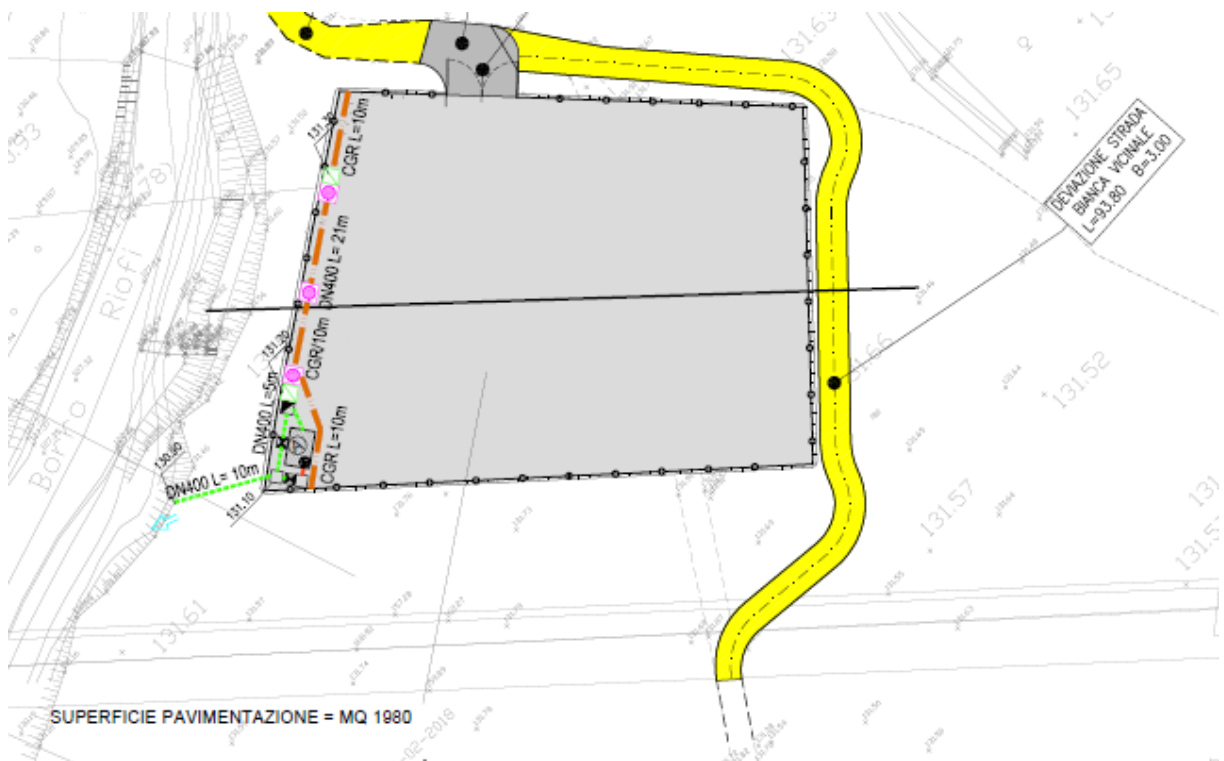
Planimetria reti idrauliche di AC02 – Area supporto progr. km 331+600
